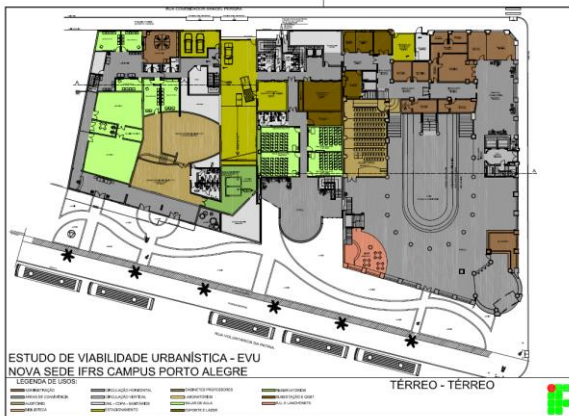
Planta baixa térreo - EVU- IFRS Poa
